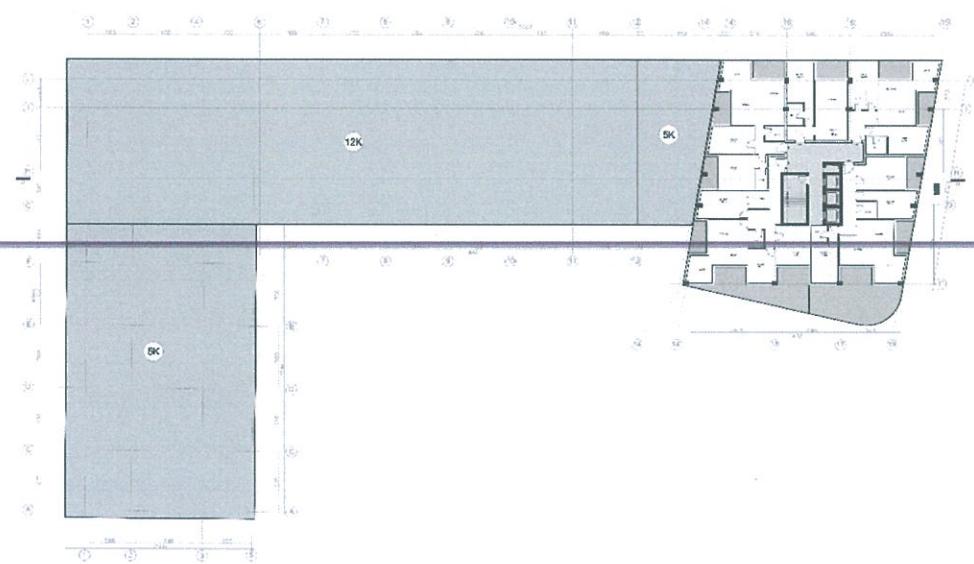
Planimetria në Kuotën +43.75 deri +75.25
